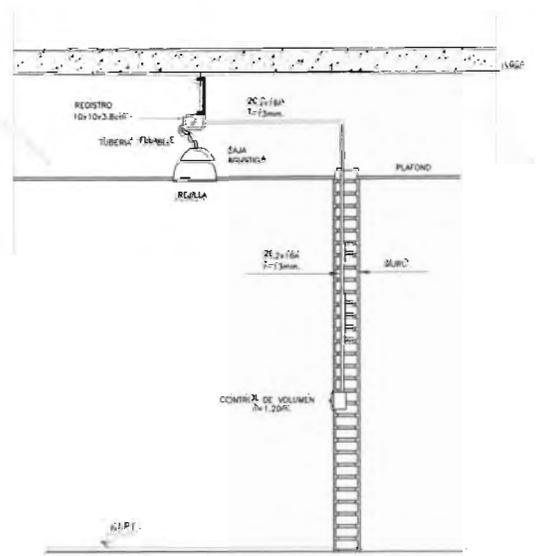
DETALLE DE INSTALACION EN PLAFOND
